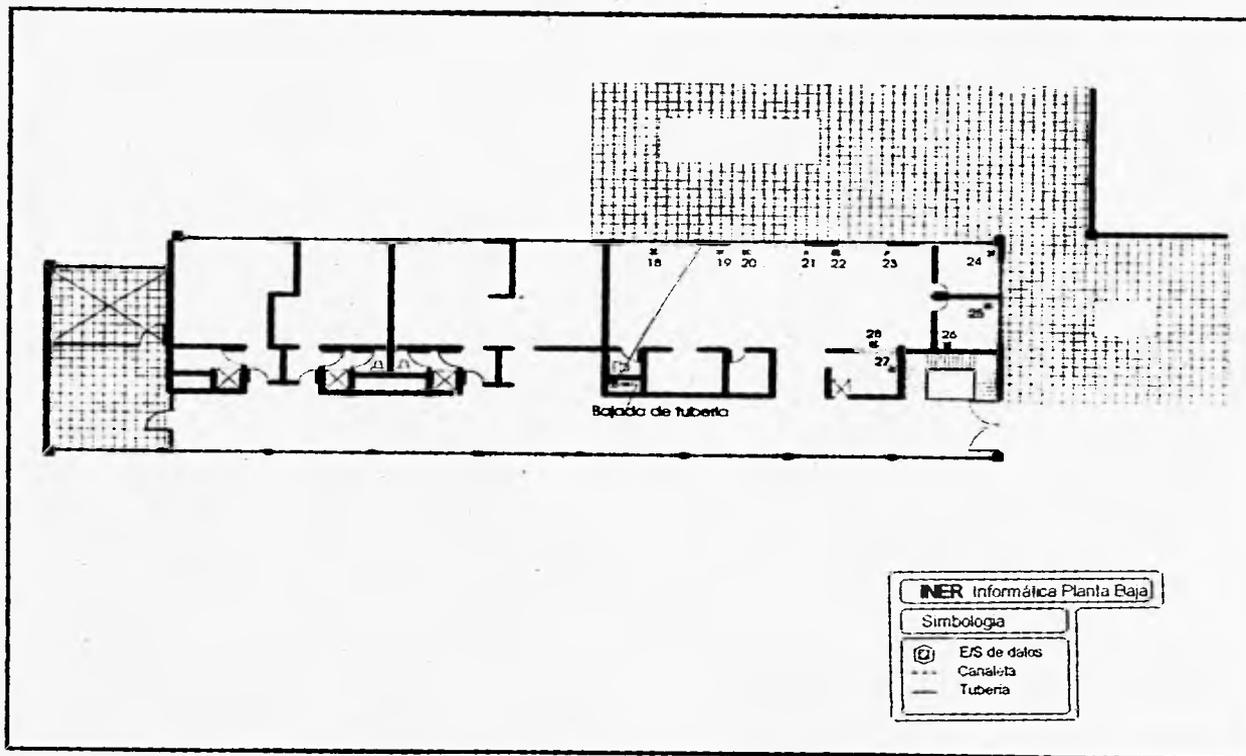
Cableado del Edificio de Informática Planta Baja
